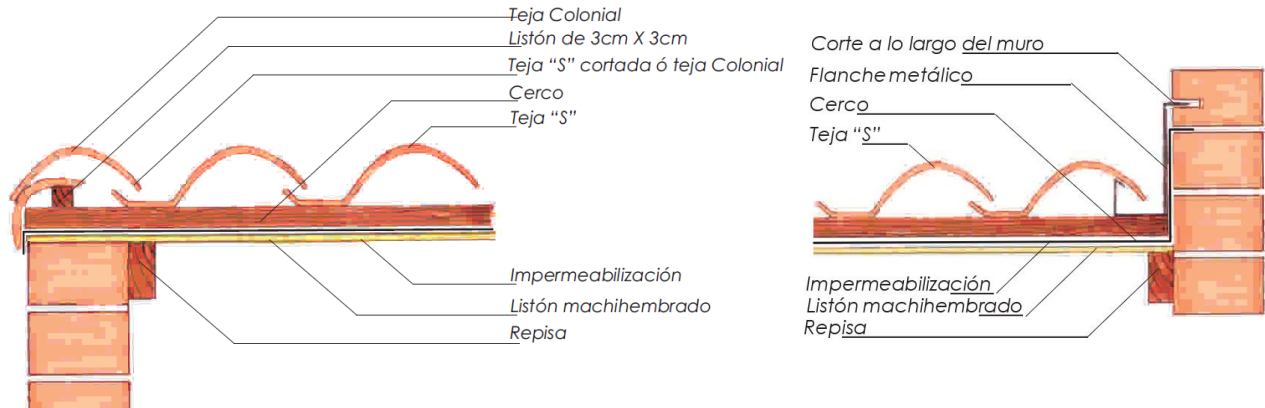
(Izquierda) Detalle remate de teja "S" contra muro lateral a nivel con teja "S" recortada teja colonial. (Derecha) Detalle remate teja "S" con muro lateral y flanche instalado previamente.
